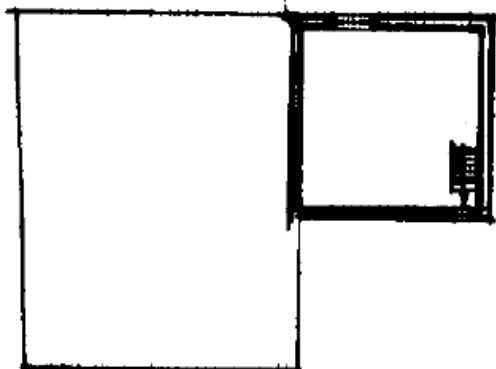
Pianta piano terra - inquadramento da planimetria - fuori scala
